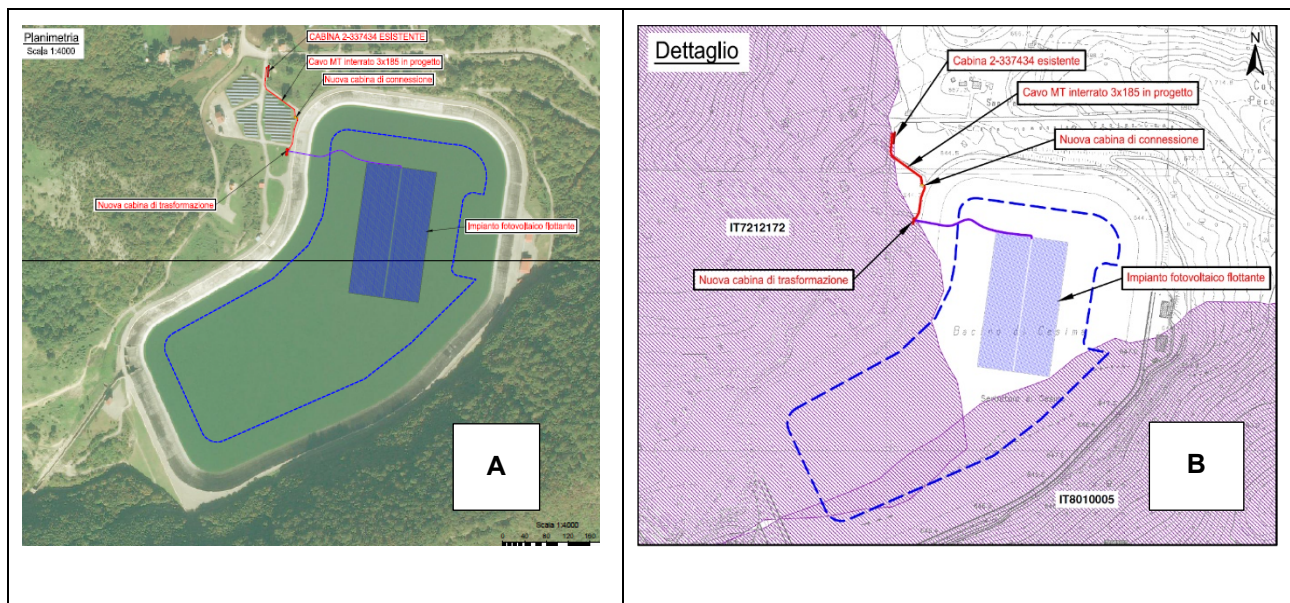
layout di progetto, inclinazione fissa verso SUD, pari a 15°
